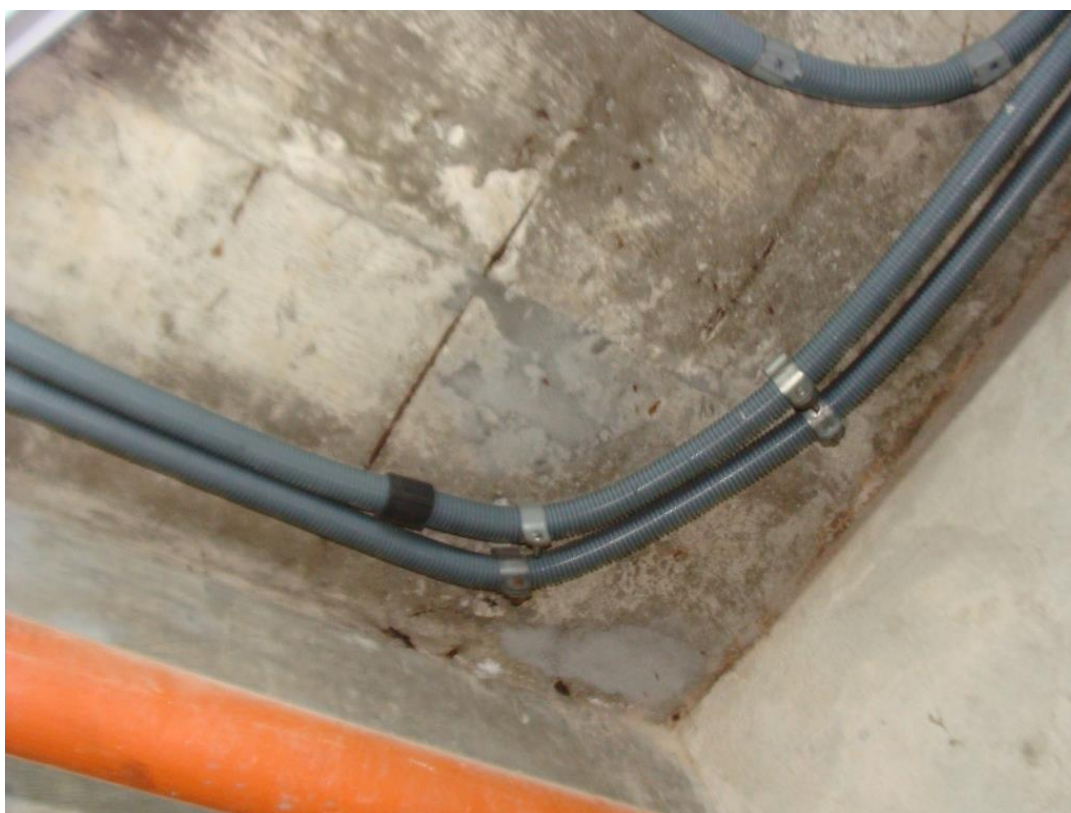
Exposição e corrosão na armadura da Laje L2 (01/03/2021)
